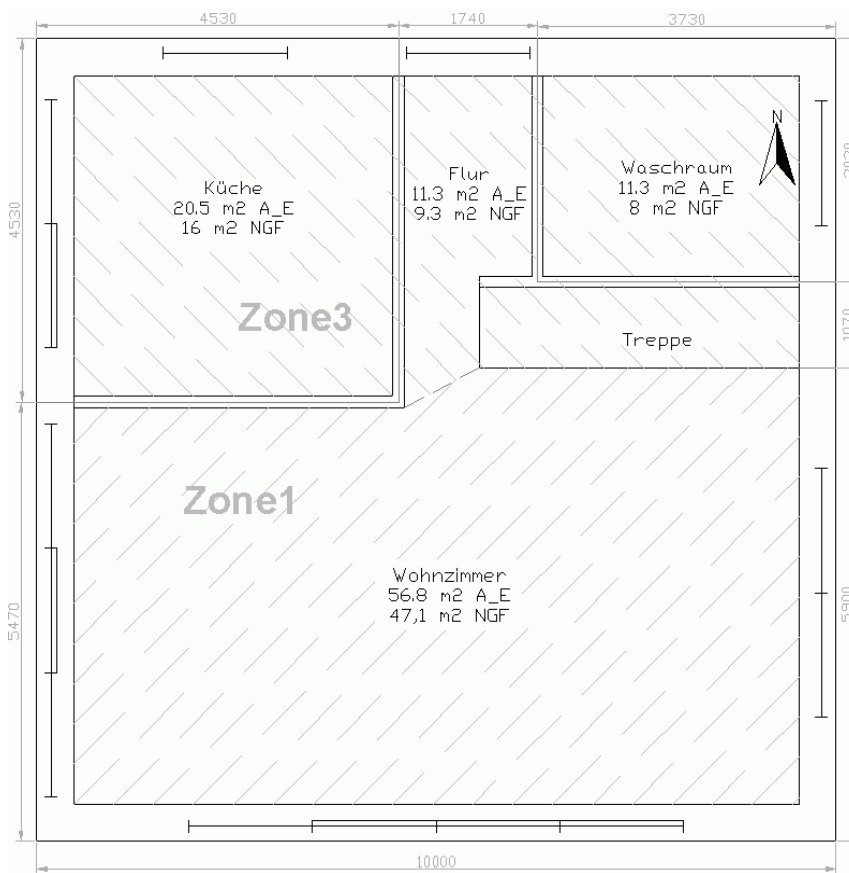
Grundriss des Minergie-P® Referenzgebäudes für das Erdgeschoss
